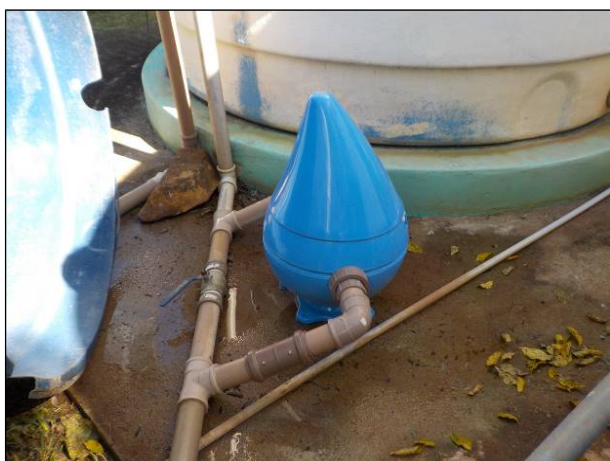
Poço 02 junto à ETA, placa em detalhe.
